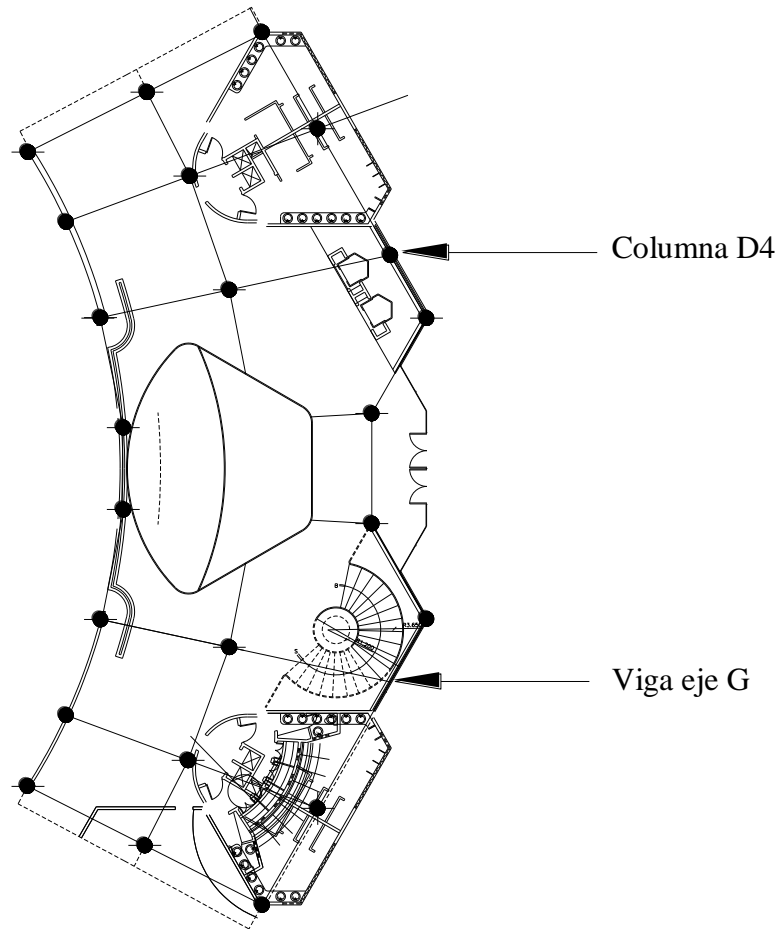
Vista en planta de la ubicación de la columna D4 y de la viga del eje G que atraviesa las gradas.
